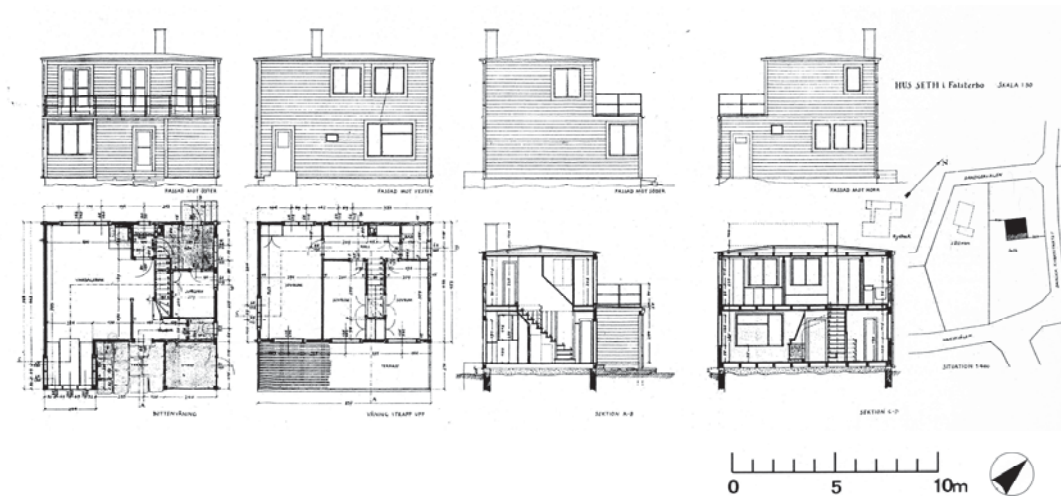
ヴィラ・セット 平面図・立面図・断面図・配置図
